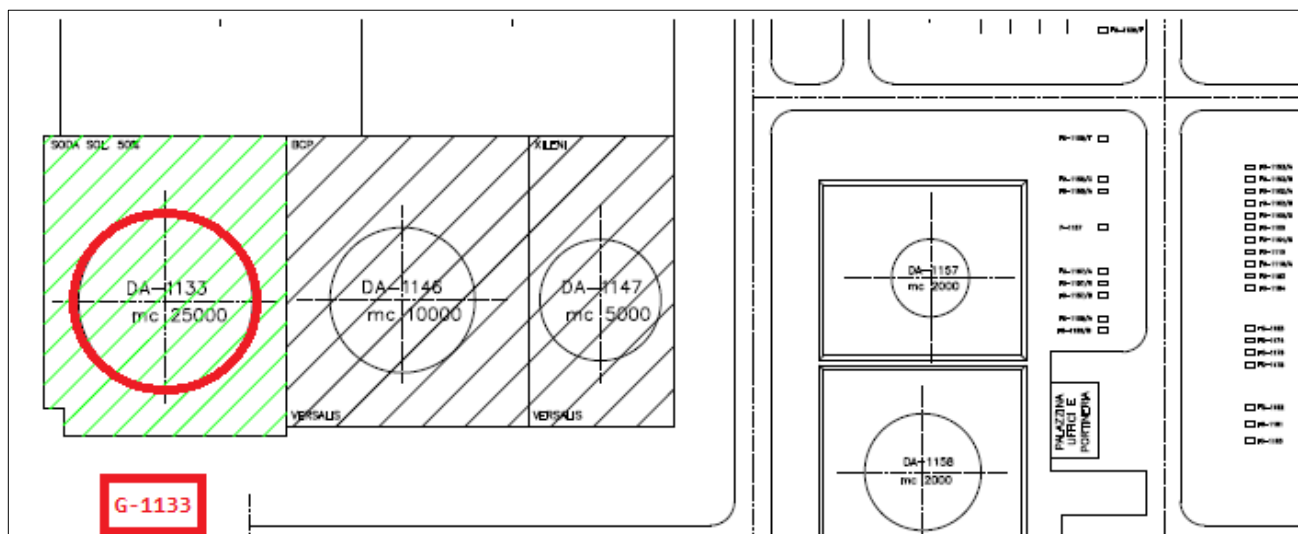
Dettaglio posizionamento planimetrico serbatoio DA1133
